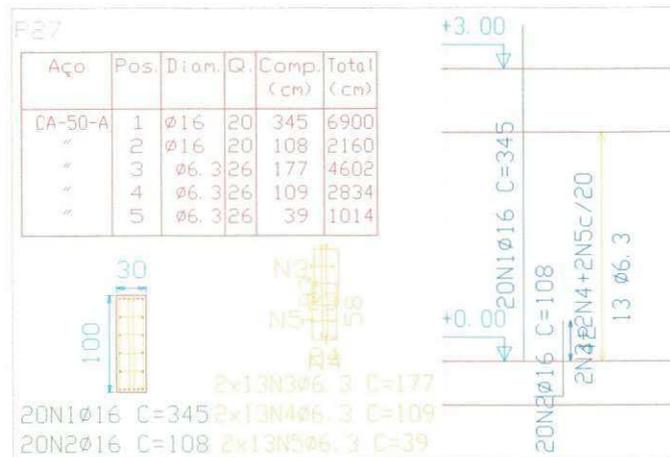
Detalhamento do pilar 27 no andar térreo.
